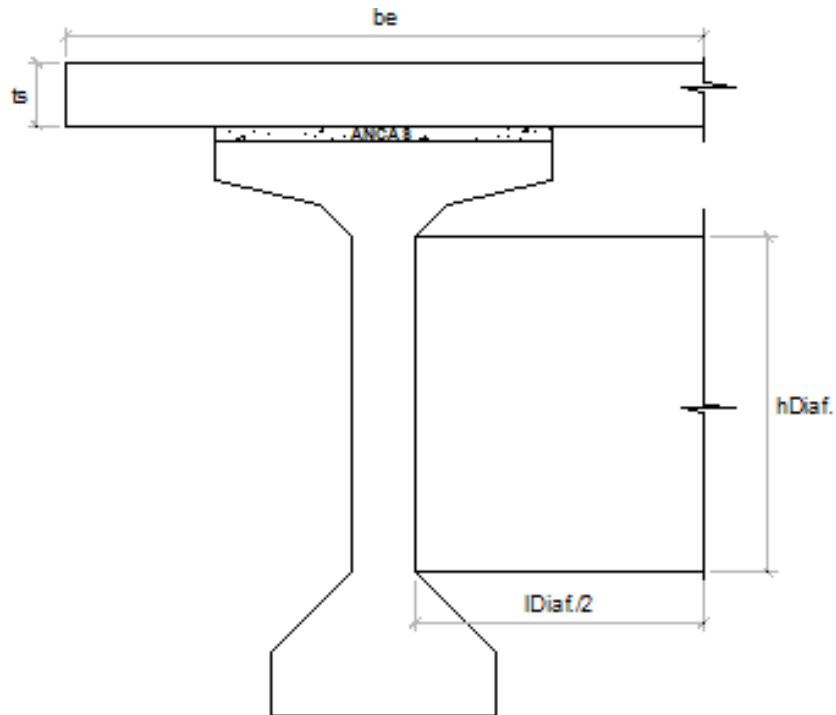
Sección Superestructura Viga Prefabricada. Fuente: Elaboración propia.
